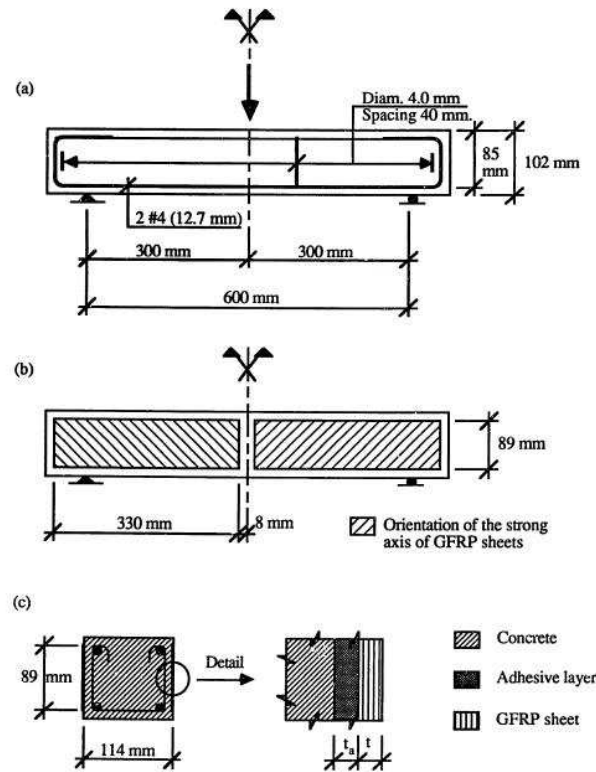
“Geometría y disposición de barras y refuerzos en las vigas ensayadas por Berset”.
